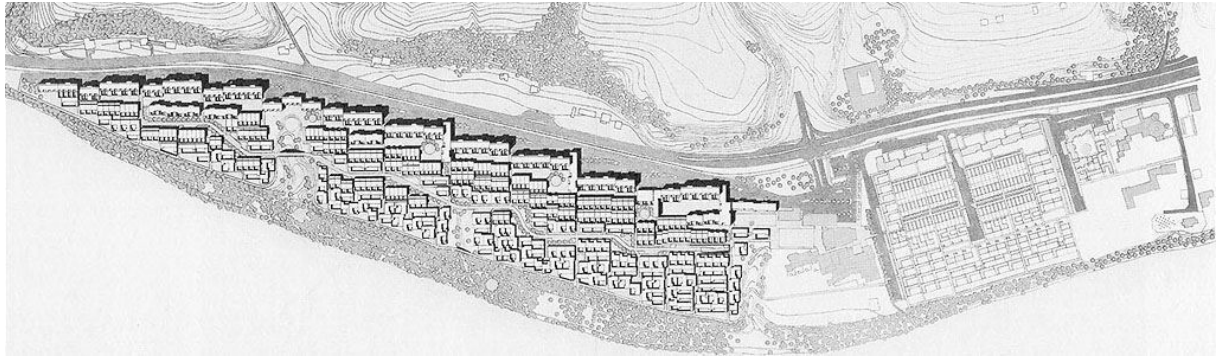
Lageplan Gartenstadt Puchenuau ([http14](http://14))
